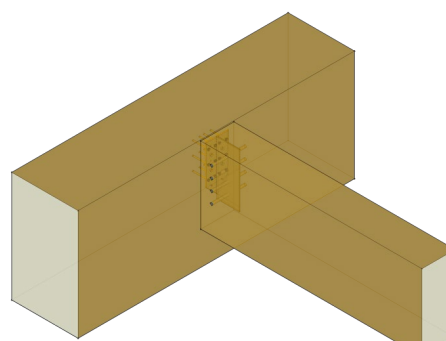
Prinzipskizzen zu Anschlüssen mit Schrauben und eingedrehten Gewindestangen
